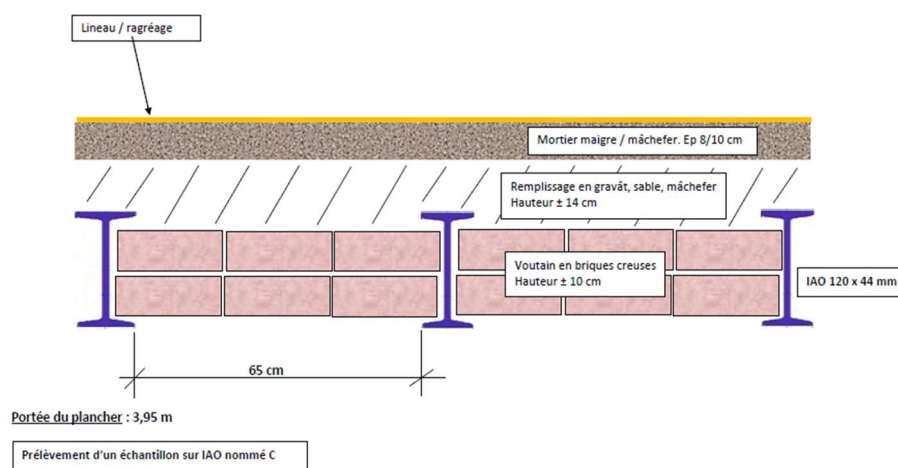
Relevé du plancher bas RDC au sondage SD3, au niveau de la sortie de secours à créer sur la façade Sud. Rapport Rincet BTP
